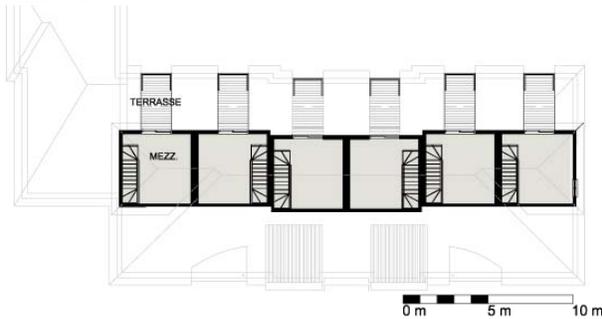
Plans des maisons en rangée (bâtiment C)
